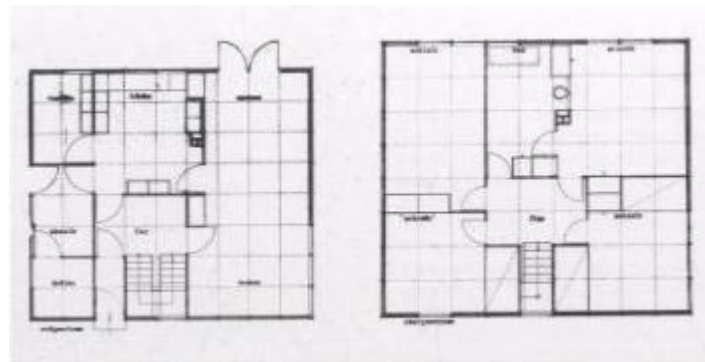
Planta de una vivienda, Gropius, Exposición Weissenhof Siedlung, Stuttgart, 1927. [66]
